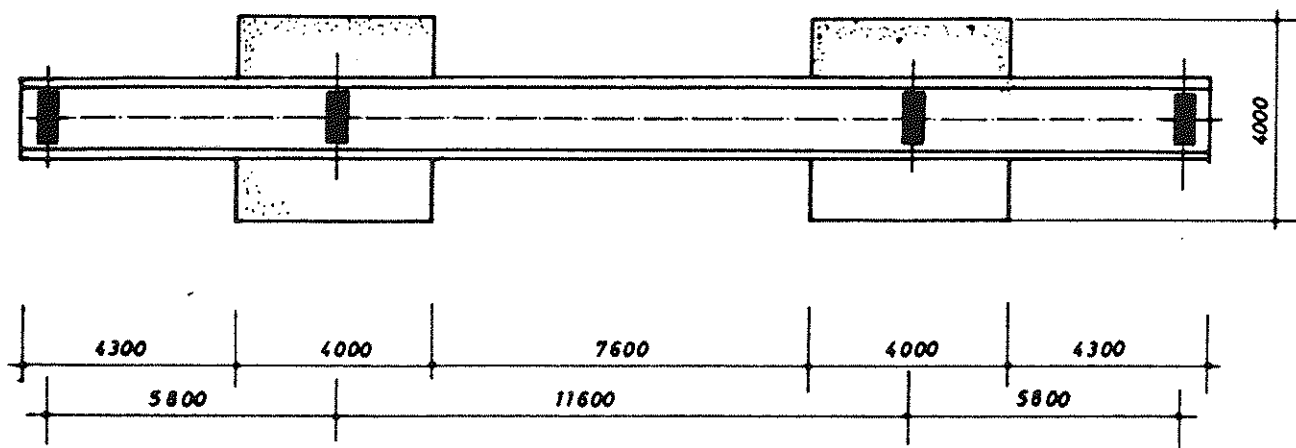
Trave di fondazione lato ospedale (zona carico - scarico)
